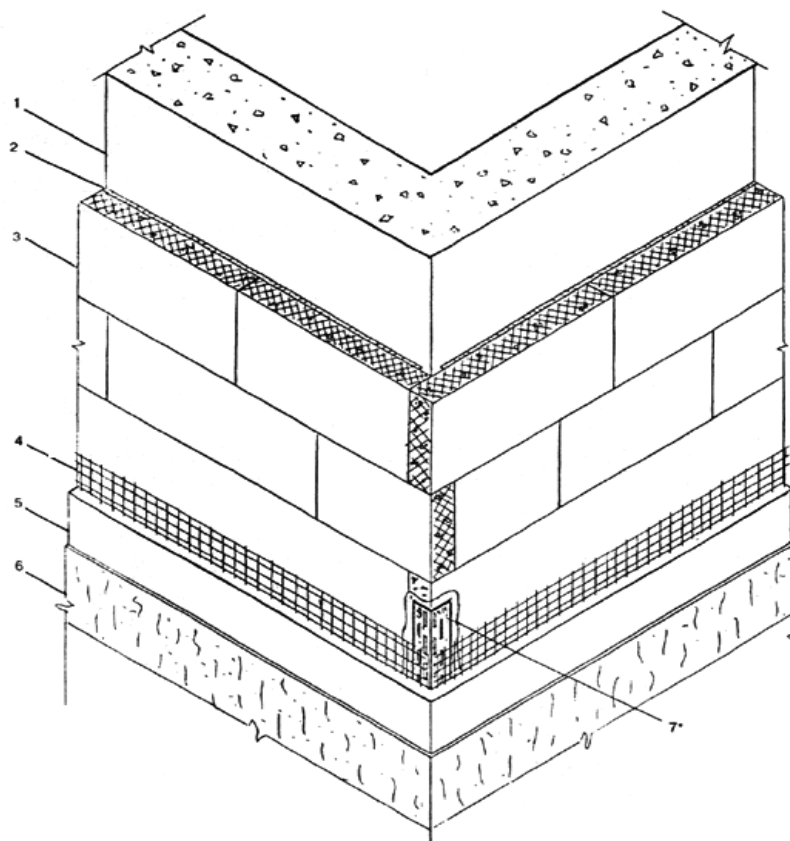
Фрагмент утепления угла фасада здания
